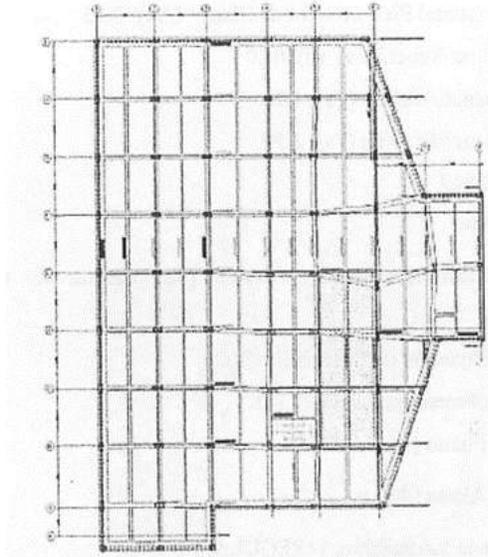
Vista en planta de diferentes configuraciones para muros de concreto.
